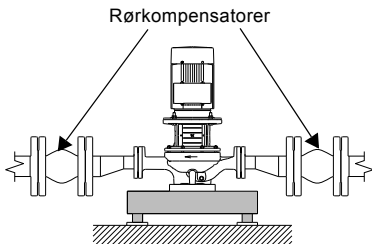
TP-pumpe installeret med større rørkompensatorer
